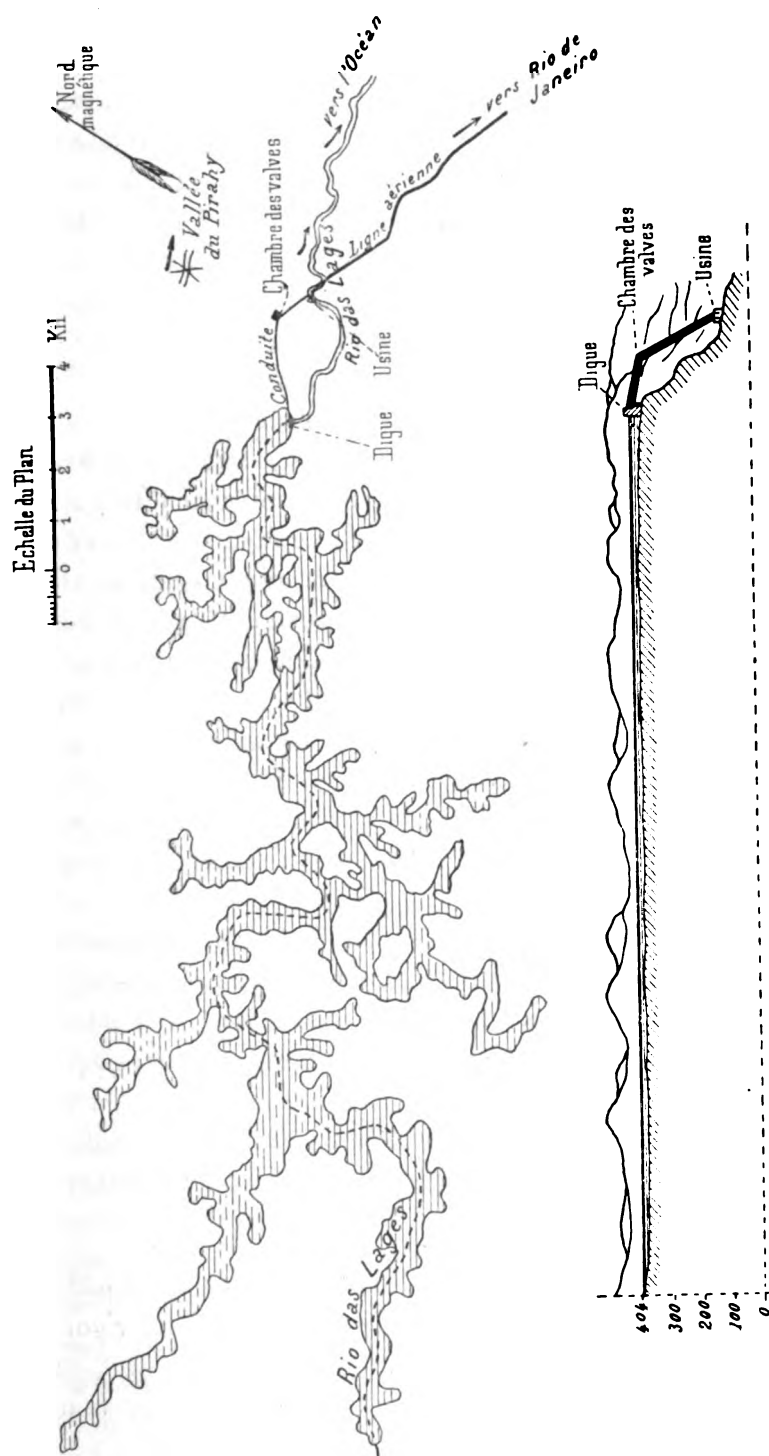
Plan et élévation du réservoir et de la conduite de descente.
